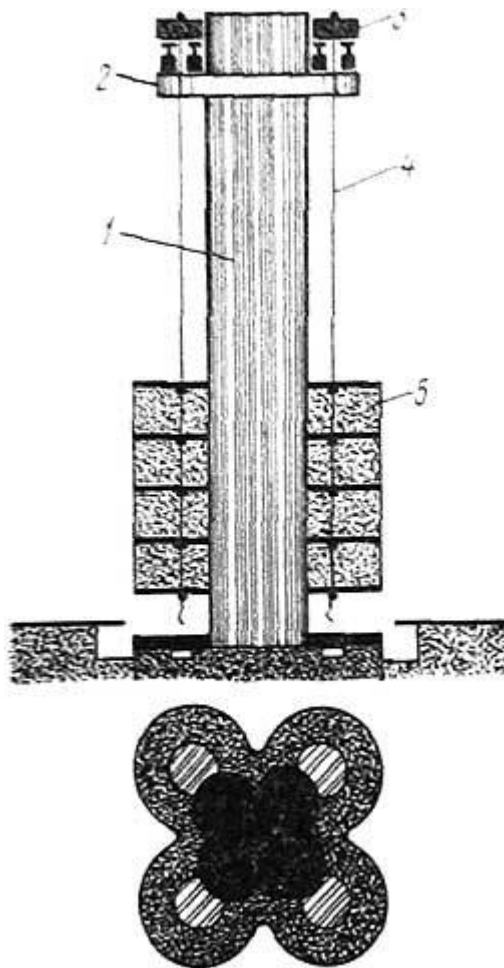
Схема монтажа здания методом подъема перекрытий (этажей)
